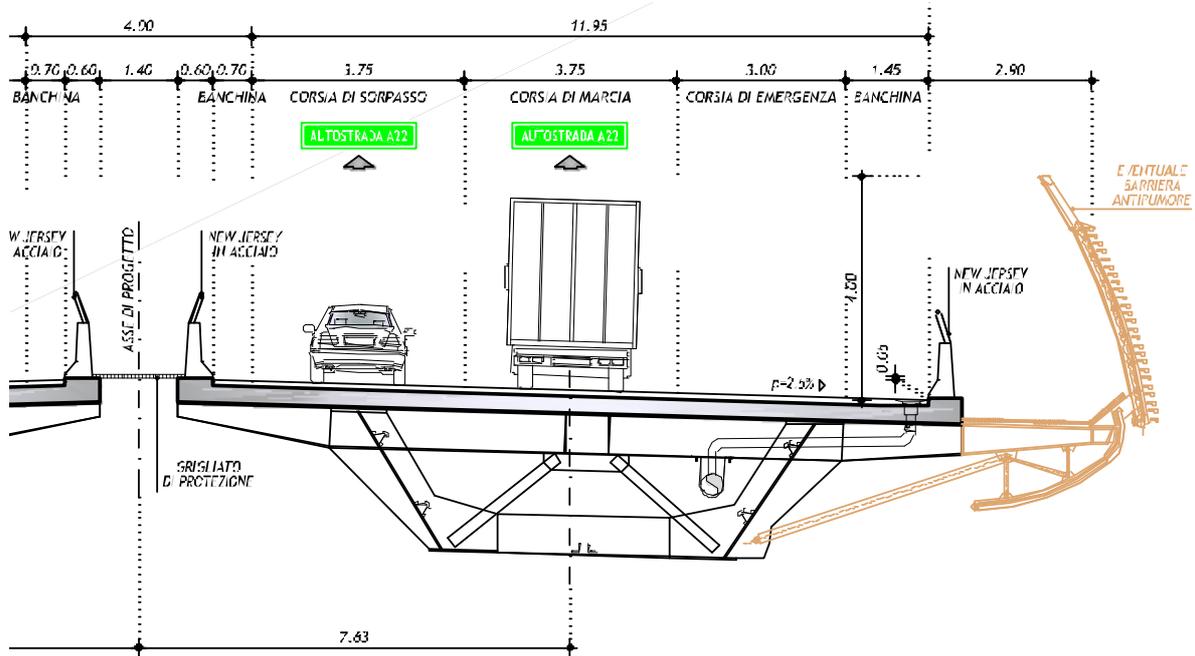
SEZIONE TIPICA IMPALCATO MISTO ACCIAIO-CLS DI PP
